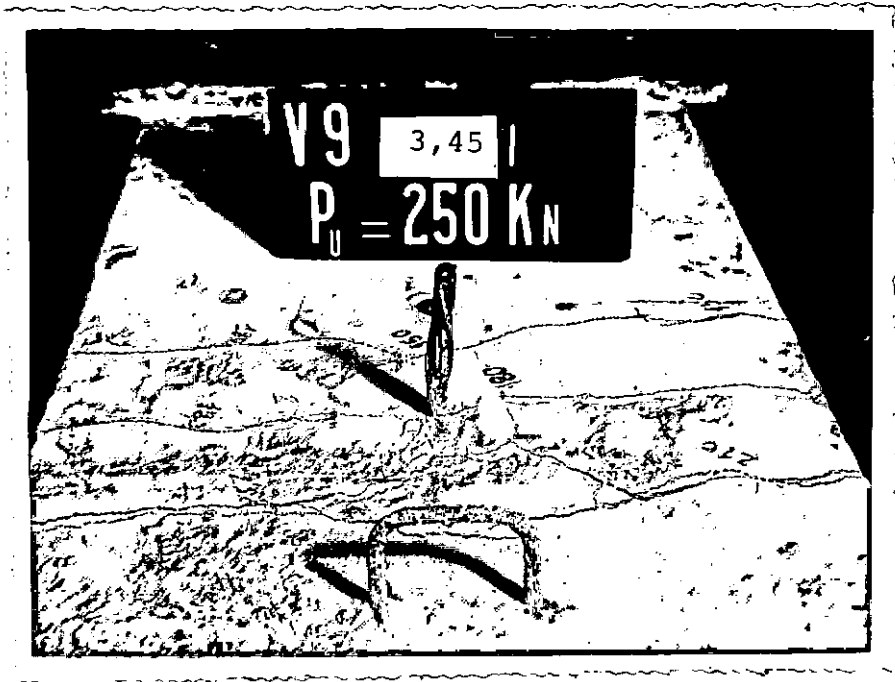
Fissuração na mesa superior da V9-3,45-I
